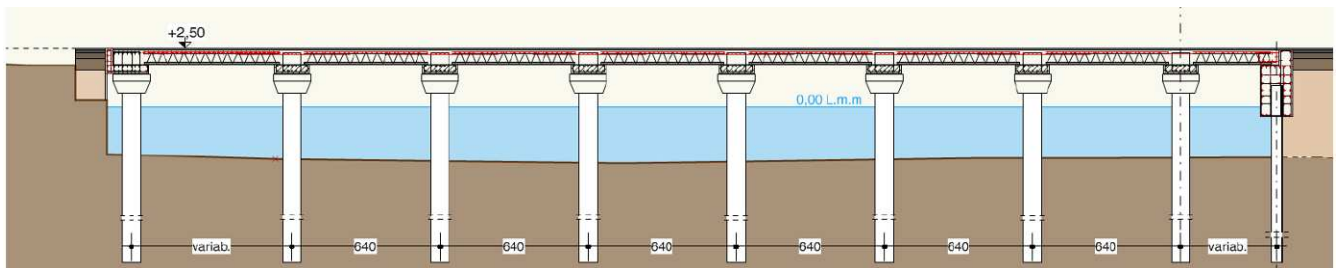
Ampliamento Fossamastra: sezione trasversale di progetto della banchina a giorno
